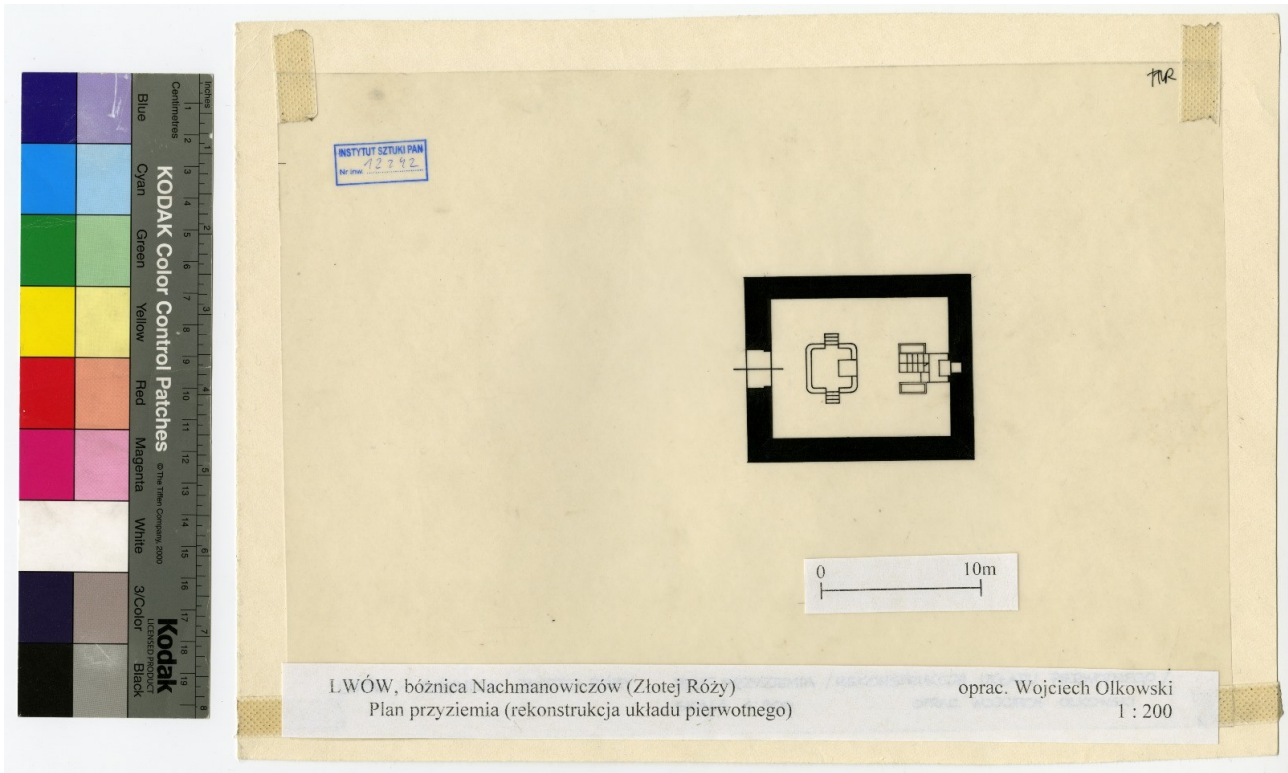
Grundriss Hauptkörper um 1600
